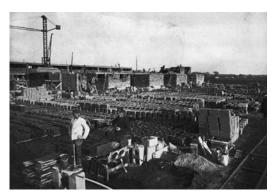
Vista del interior de la parcela durante las obras y prefabricados de hormigón in situ (*Nerdinger 1988*)
